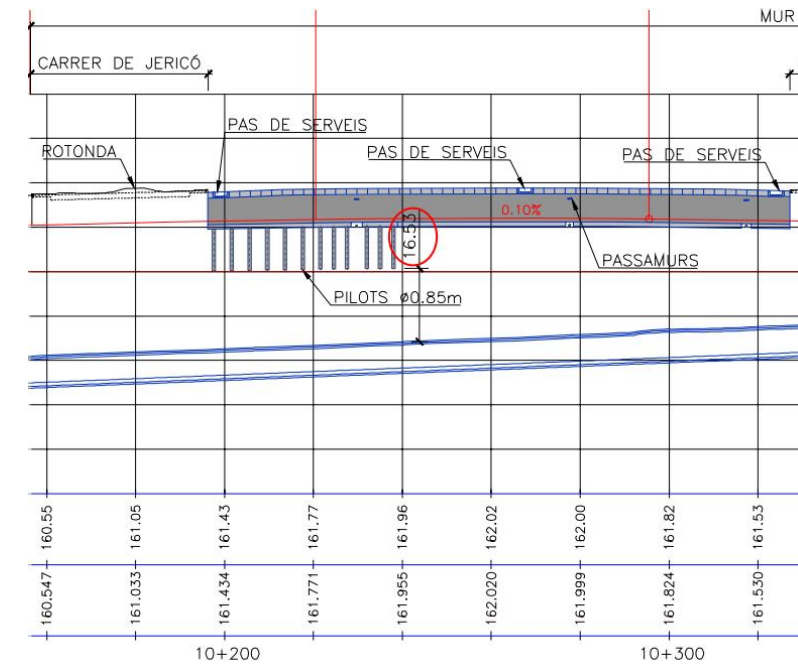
Vista lateral amb la projecció del recobriment pilons-túnel malgrat que no hi ha solapament en planta entre el mur i el túnel
